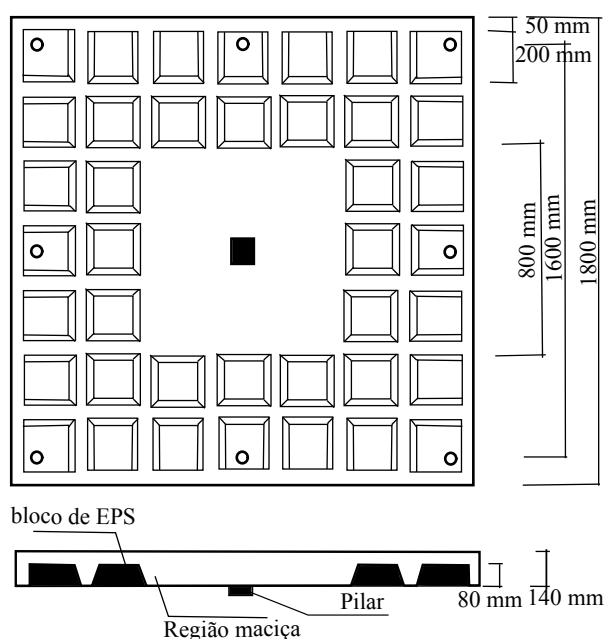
Dimensões das lajes ensaiadas, Souza (2007)
